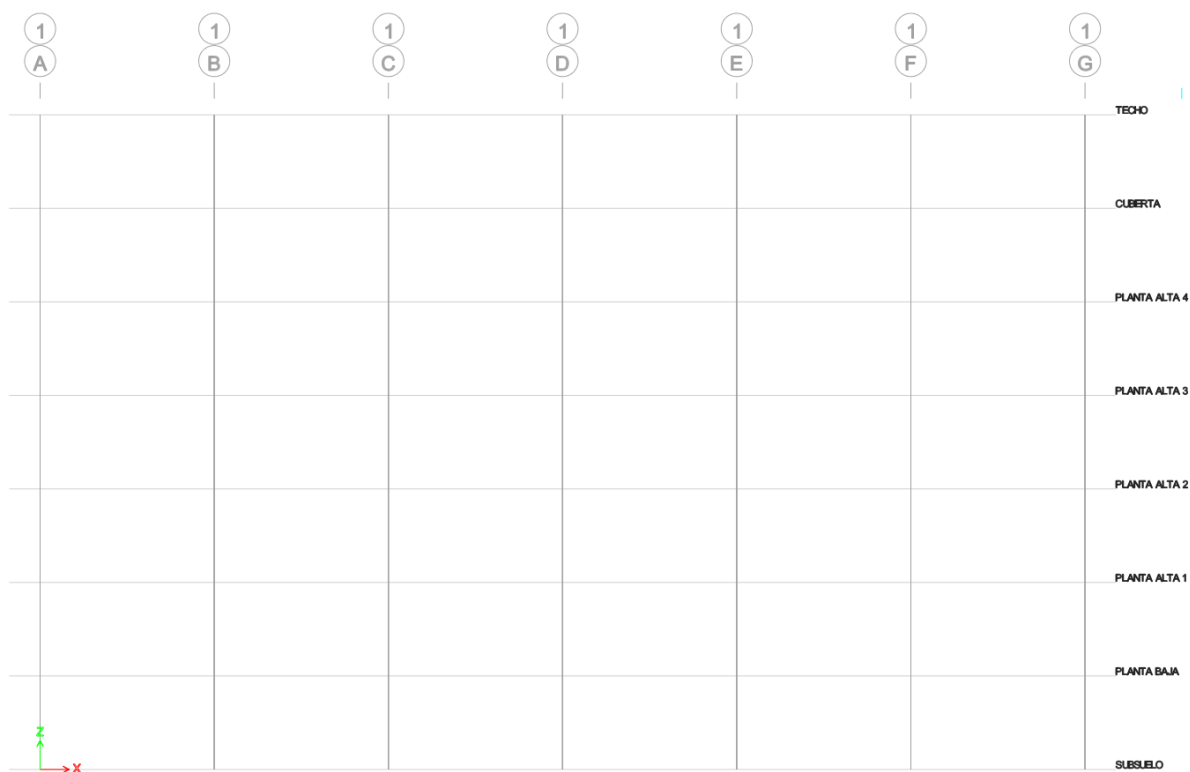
Definición de ejes en planta y elevación. Altura entrepiso: 2.9m
